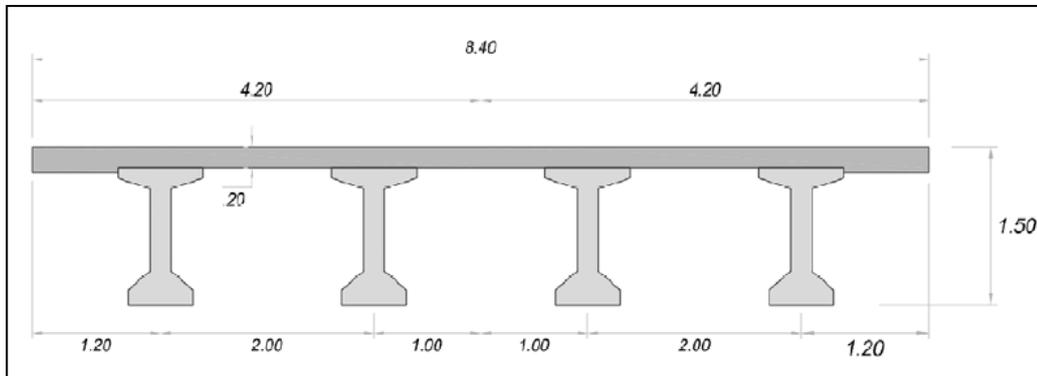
Muestra posición de vigas en tablero de Viaducto
